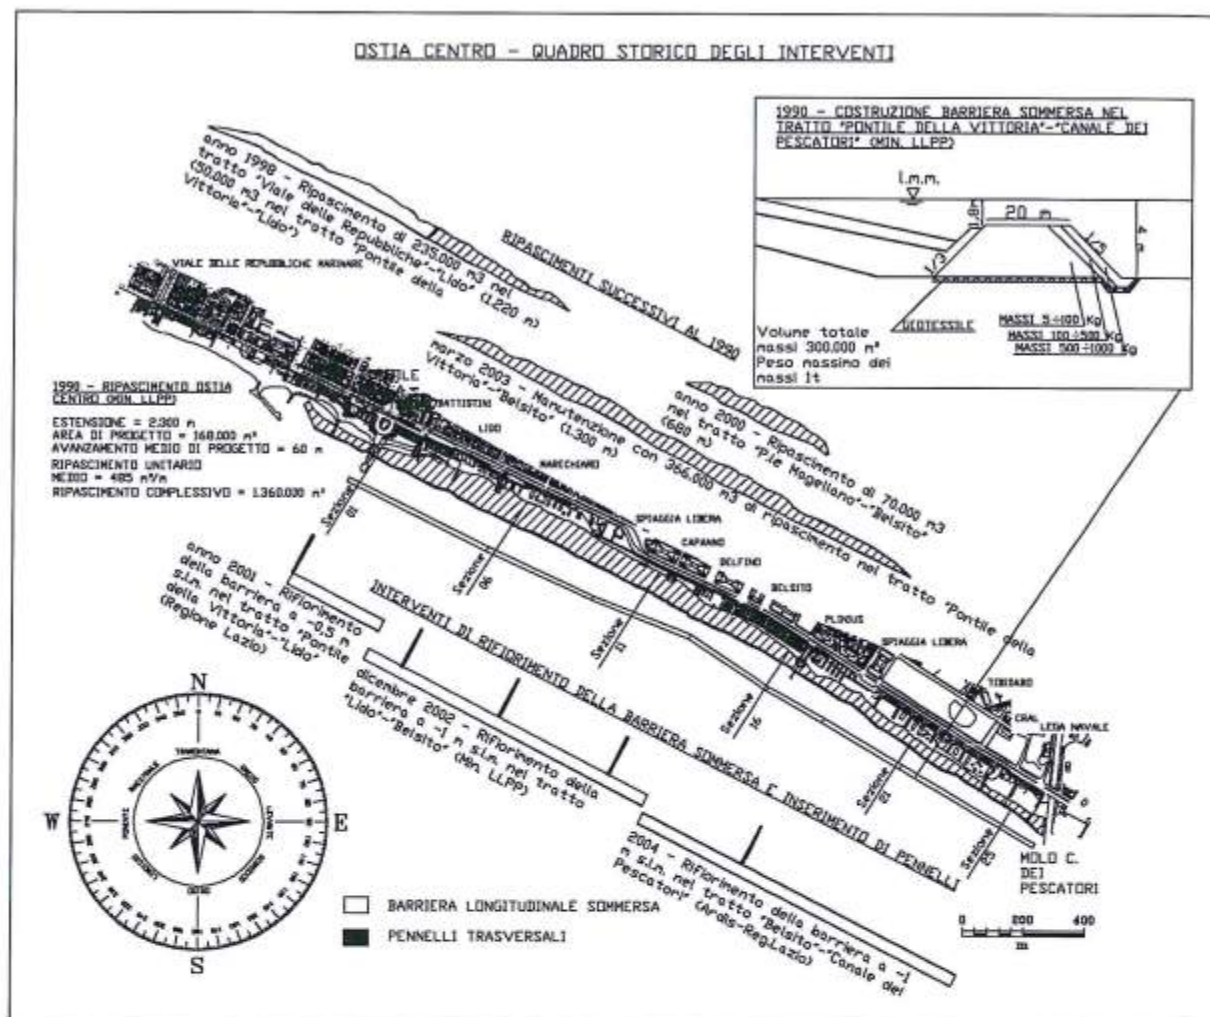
Planimetria con indicazione degli interventi e delle sezioni di riferimento. Nel riquadro è illustrato lo schema della sezione della struttura sommersa.
